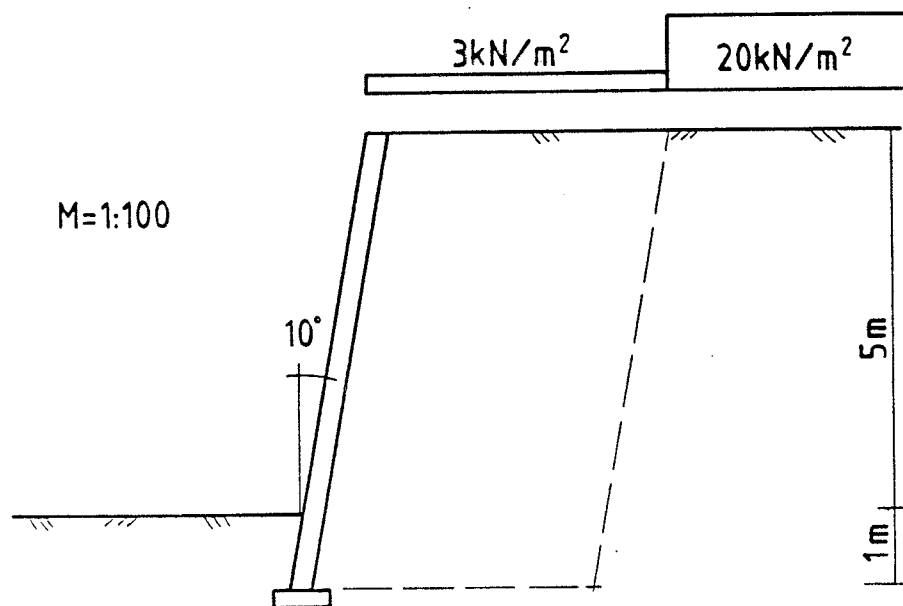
STØTTEKONSTRUKSJON I ARMERT JORD
